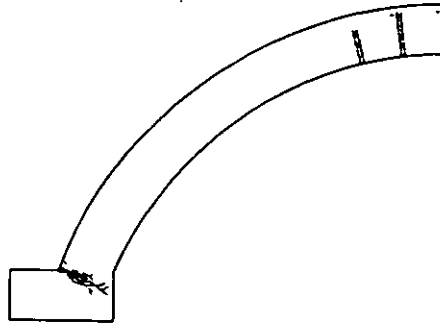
Configuración de grietas por abertura de apoyos en arco
